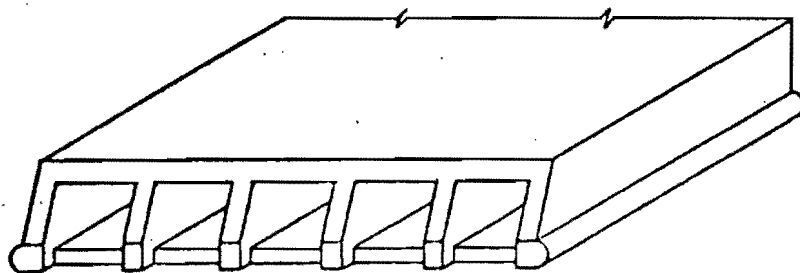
Detalle del borde de un panel-muro (ref 3)
